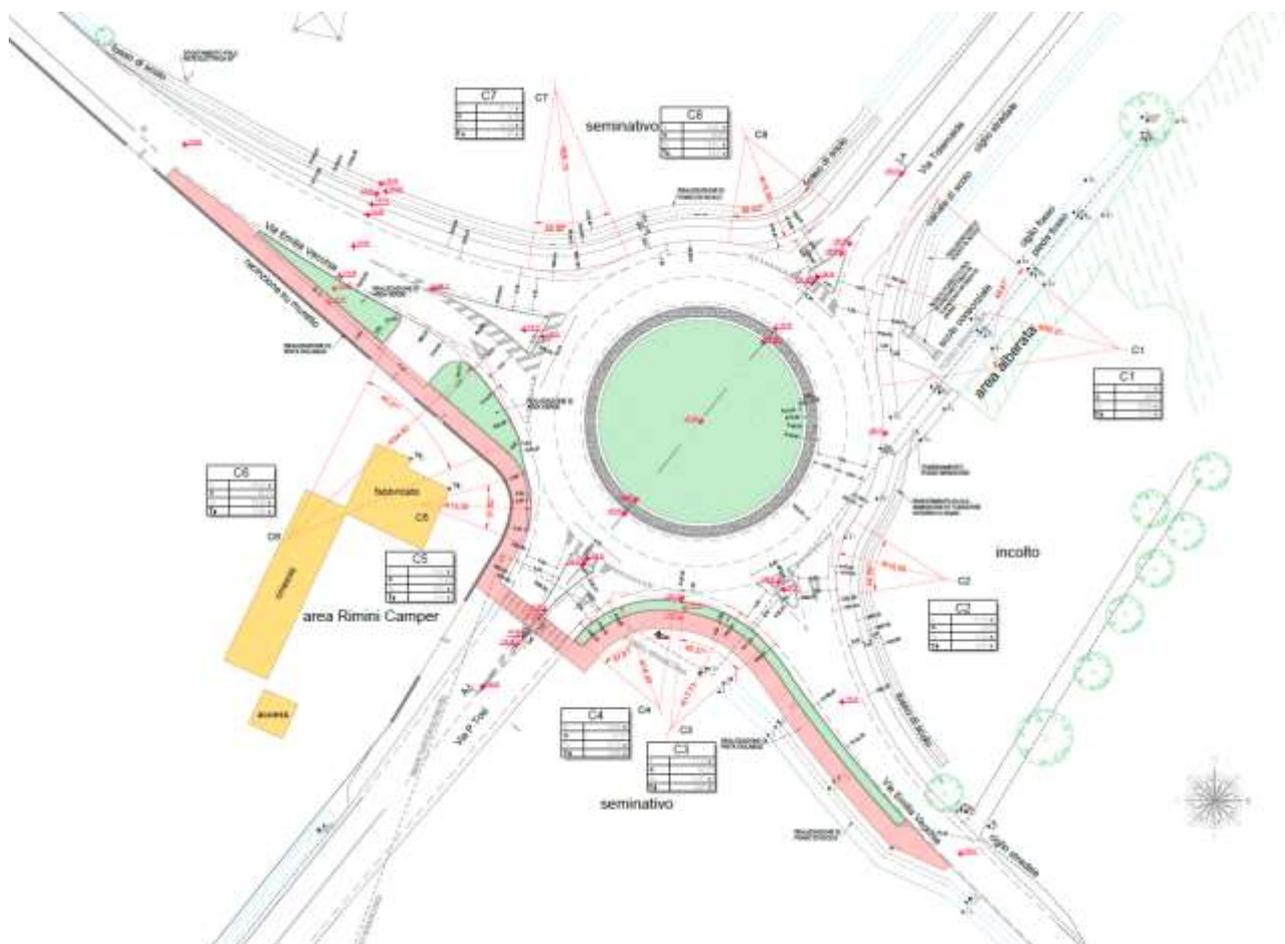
a – planimetria di progetto con traccia di sezione AA
